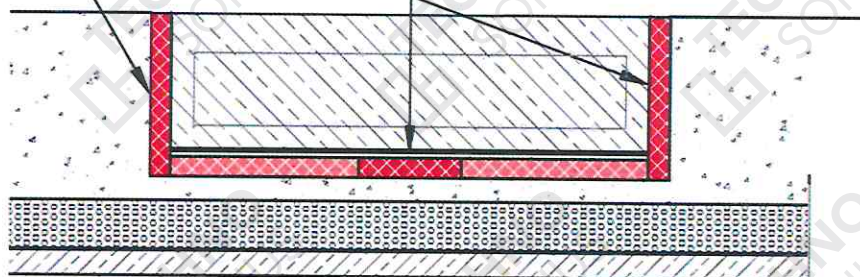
Конструкция системы виброизоляции с применением точечной раскладки (тип С.1) виброизоляционного материала под плавающий фундамент. Вид сбоку.
